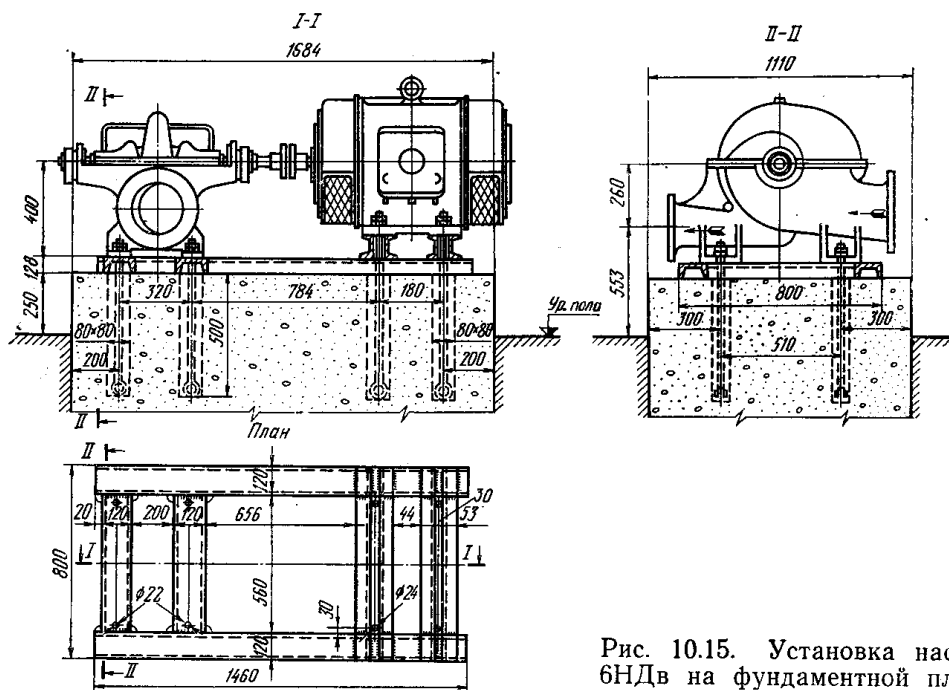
Установка насоса 6НДв на фундаментной плите
